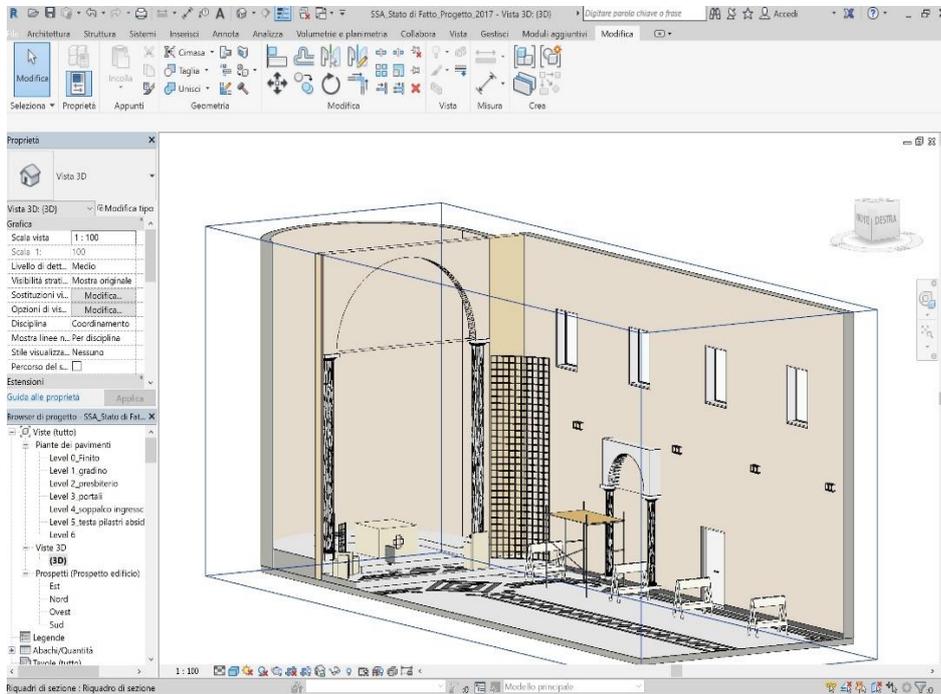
Modellazione BIM, particolare dell'inserimento degli apprestamenti e della divisione fisica delle location Divisione dell'edificio in location. Caso 1.
